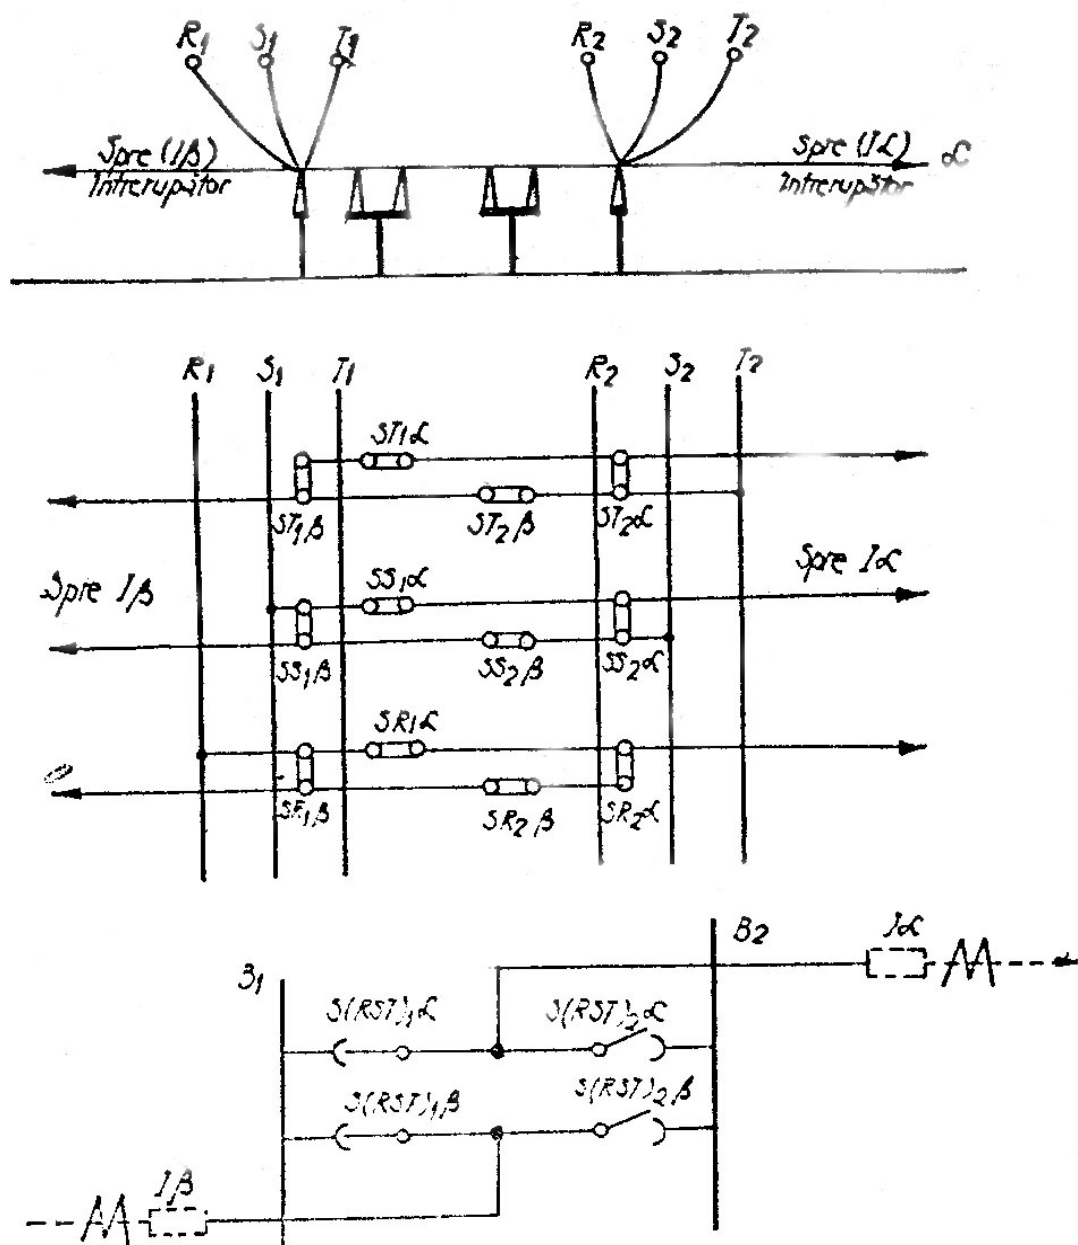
Plan și secțiune prin două celule într-o instalație cu separatoarele de bare așezate în unghi drept.
